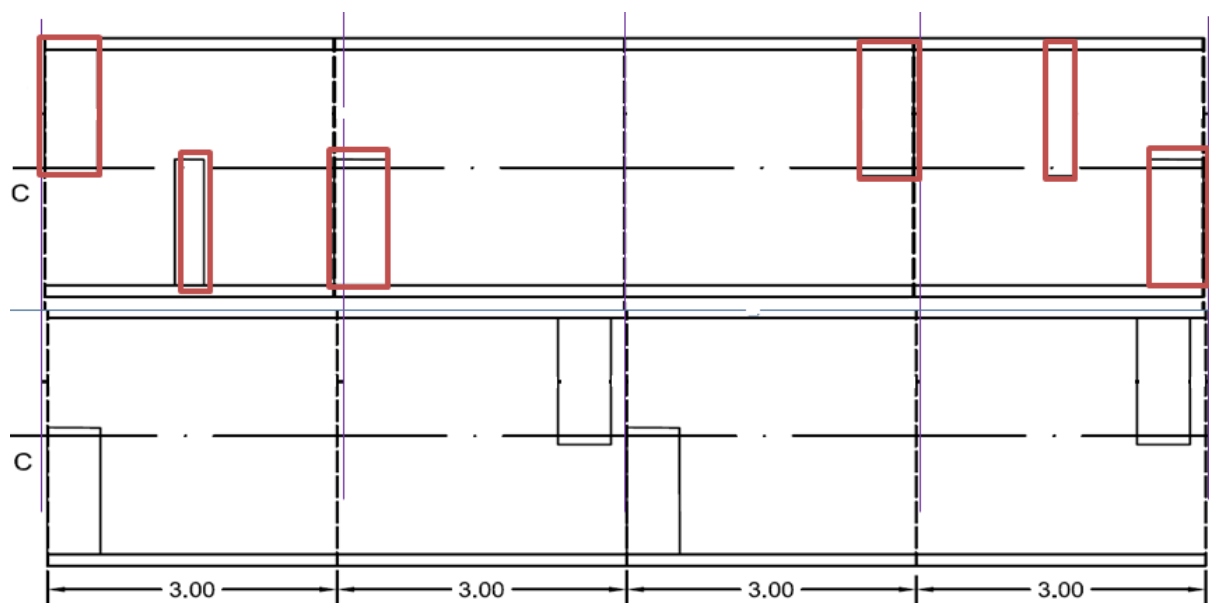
Localização dos painéis de alumínio nas camadas de leito do pavimento e fundação
